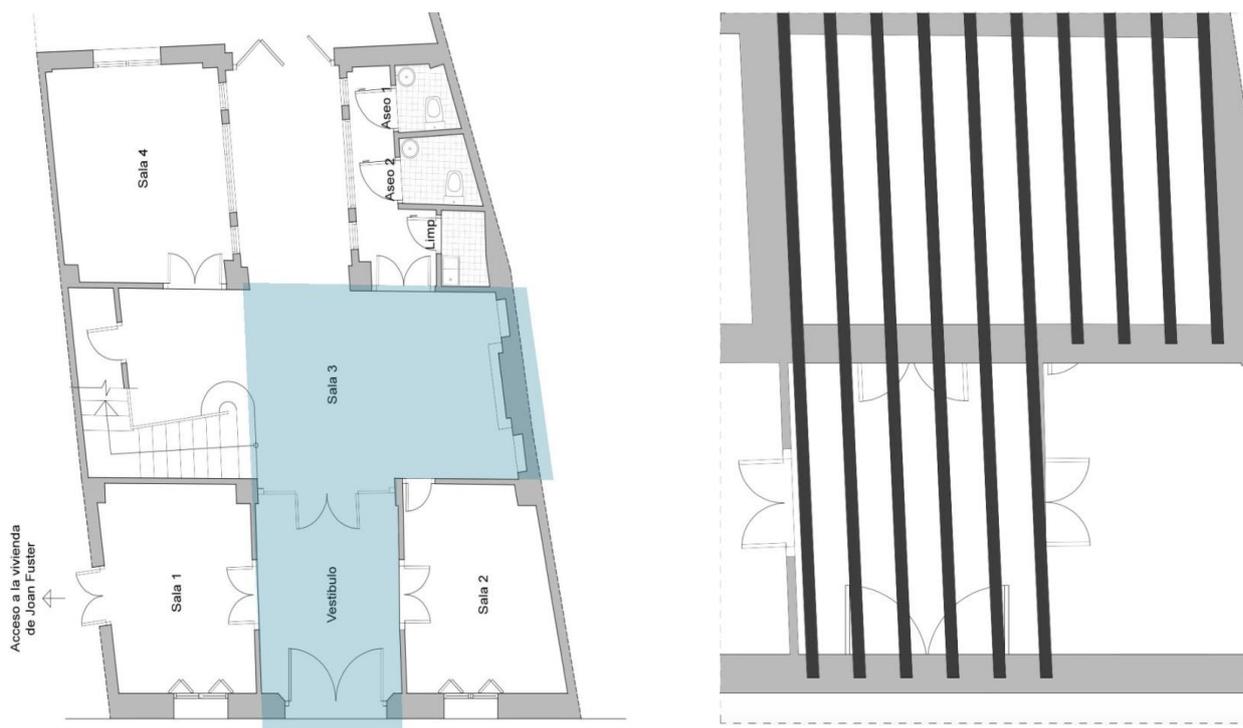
Disposición de las viguetas vistas en el forjado de planta baja.
